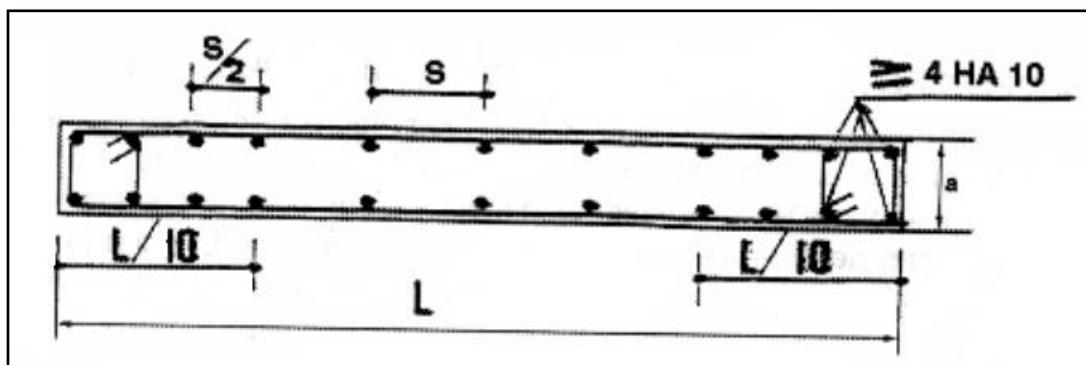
Disposition des armatures verticales dans les voiles.
